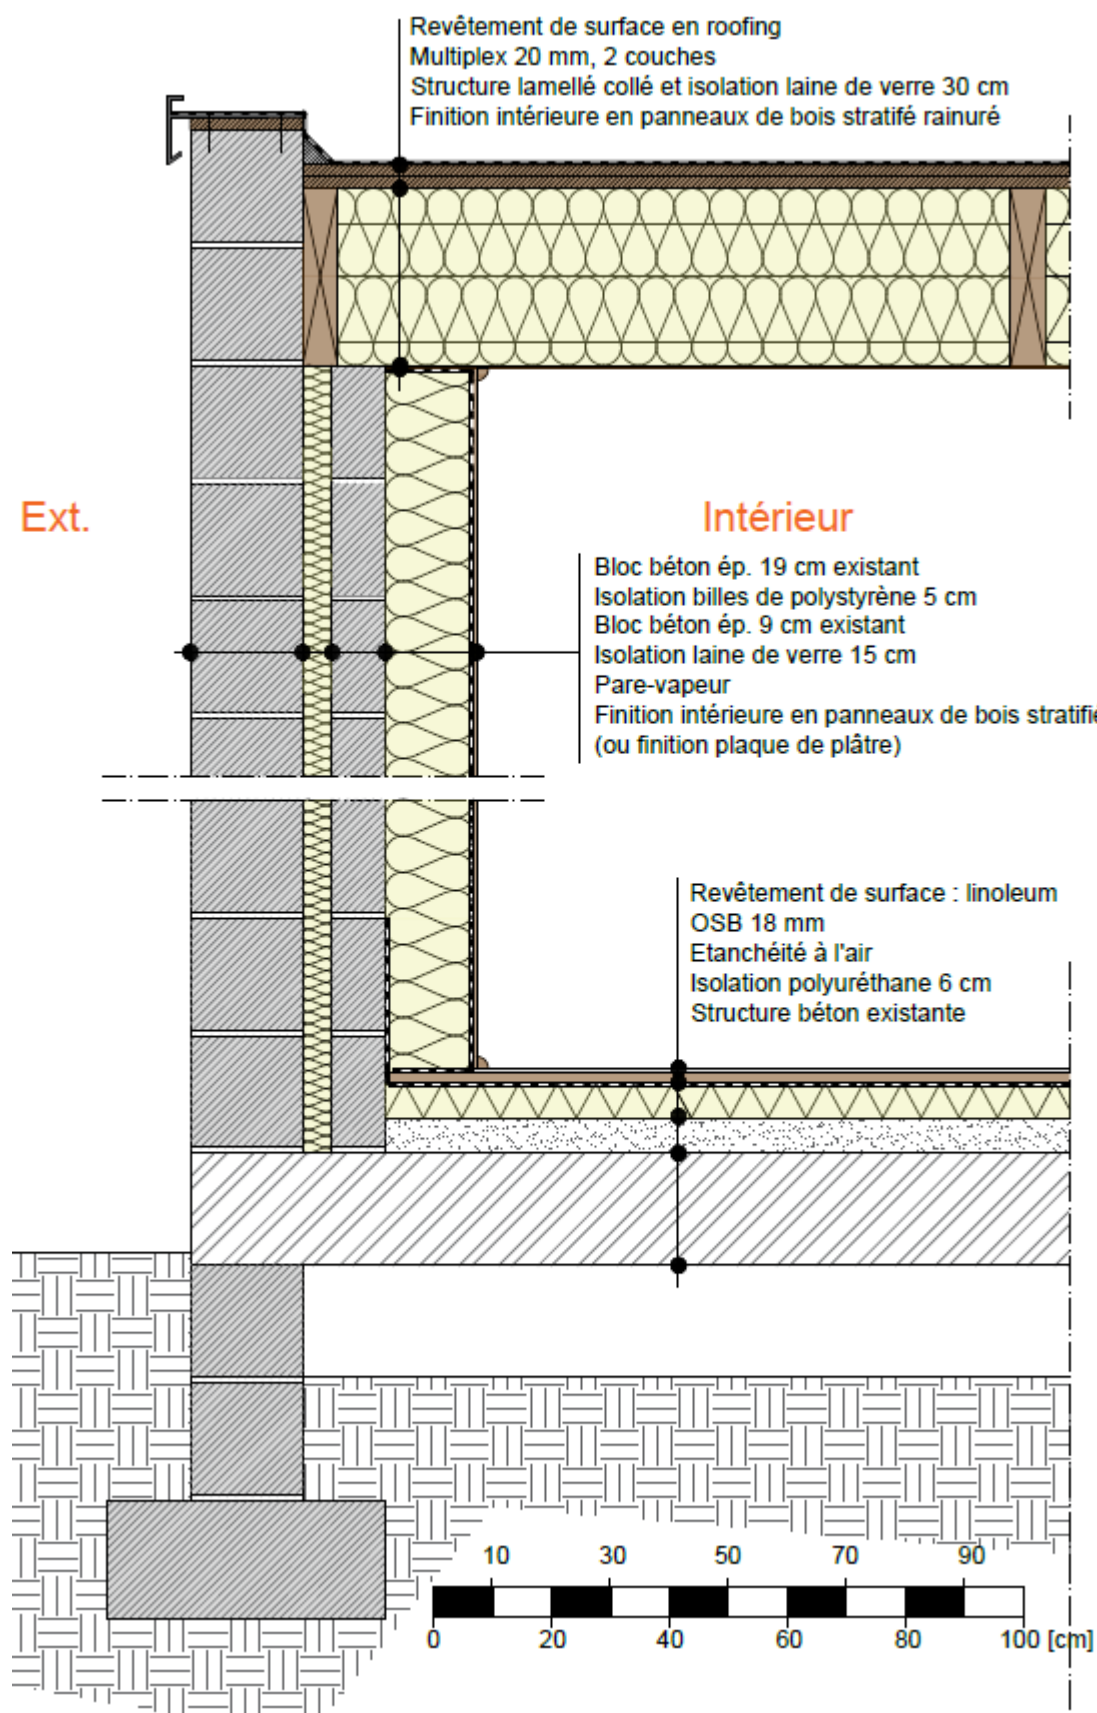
Coupe verticale : jonction plancher/façade et façade/toiture (scénario 2)
